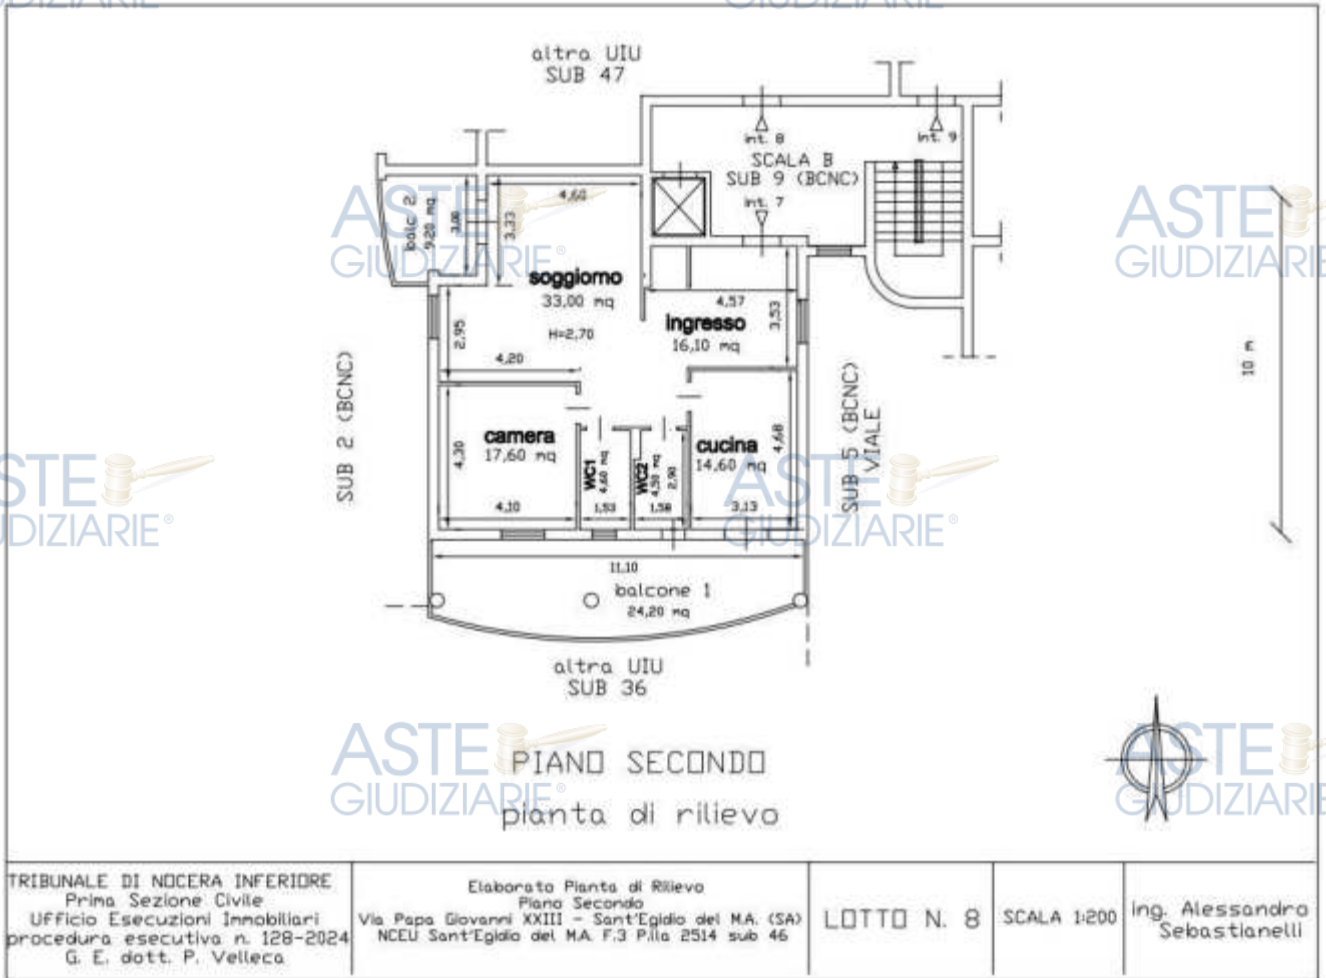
Planimetria stato di rilievo appartamento lotto 8
